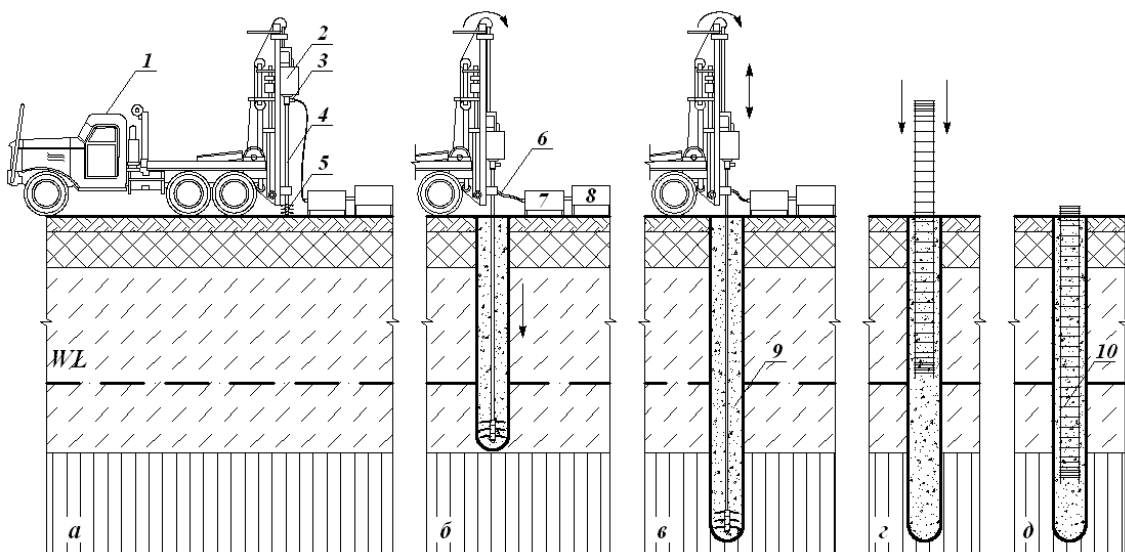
Схема виготовлення ґрунтоцементних паль за бурозмішувальним методом: а – бурове обладнання; б – розпушування ґрунту з нагнітанням водоцементного розчину; в – перемішування суміші; г – встановлення арматурного каркасу; д – загальний вигляд ґрунтоцементної палі; 1 – автомобіль із буровим станком; 2 – силовий привід; 3 – вертлюг; 4 – бурова труба; 5 – ріжучий інструмент; 6 – напірний рукав для подачі водоцементного розчину; 7 – буровий насос; 8 – розчинозмішувач; 9 – ґрунтоцементний елемент; 10 – ґрунтоцементна палля
